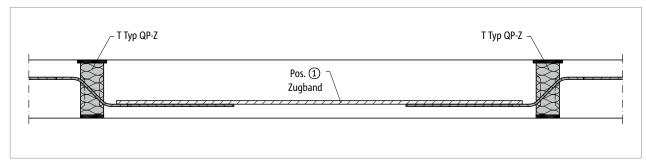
Schöck Isokorb® T Typ QP-Z: Schnitt A-A; Bewehrungsanschluss Zugband
